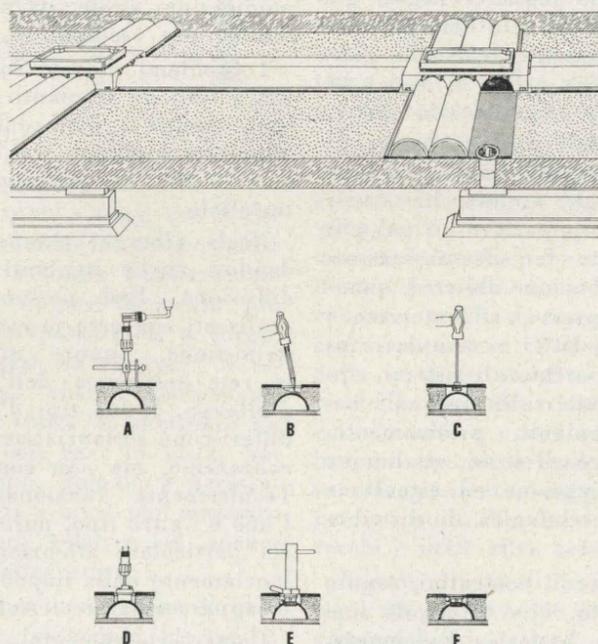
Distribuzione modulare elastica con manufatti annegati nel pavimento.
